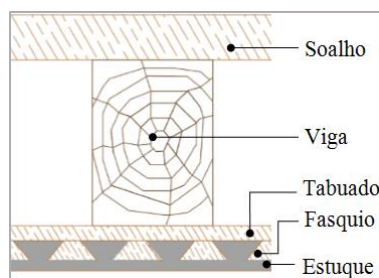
Esquema da solução de pavimento existente com teto
